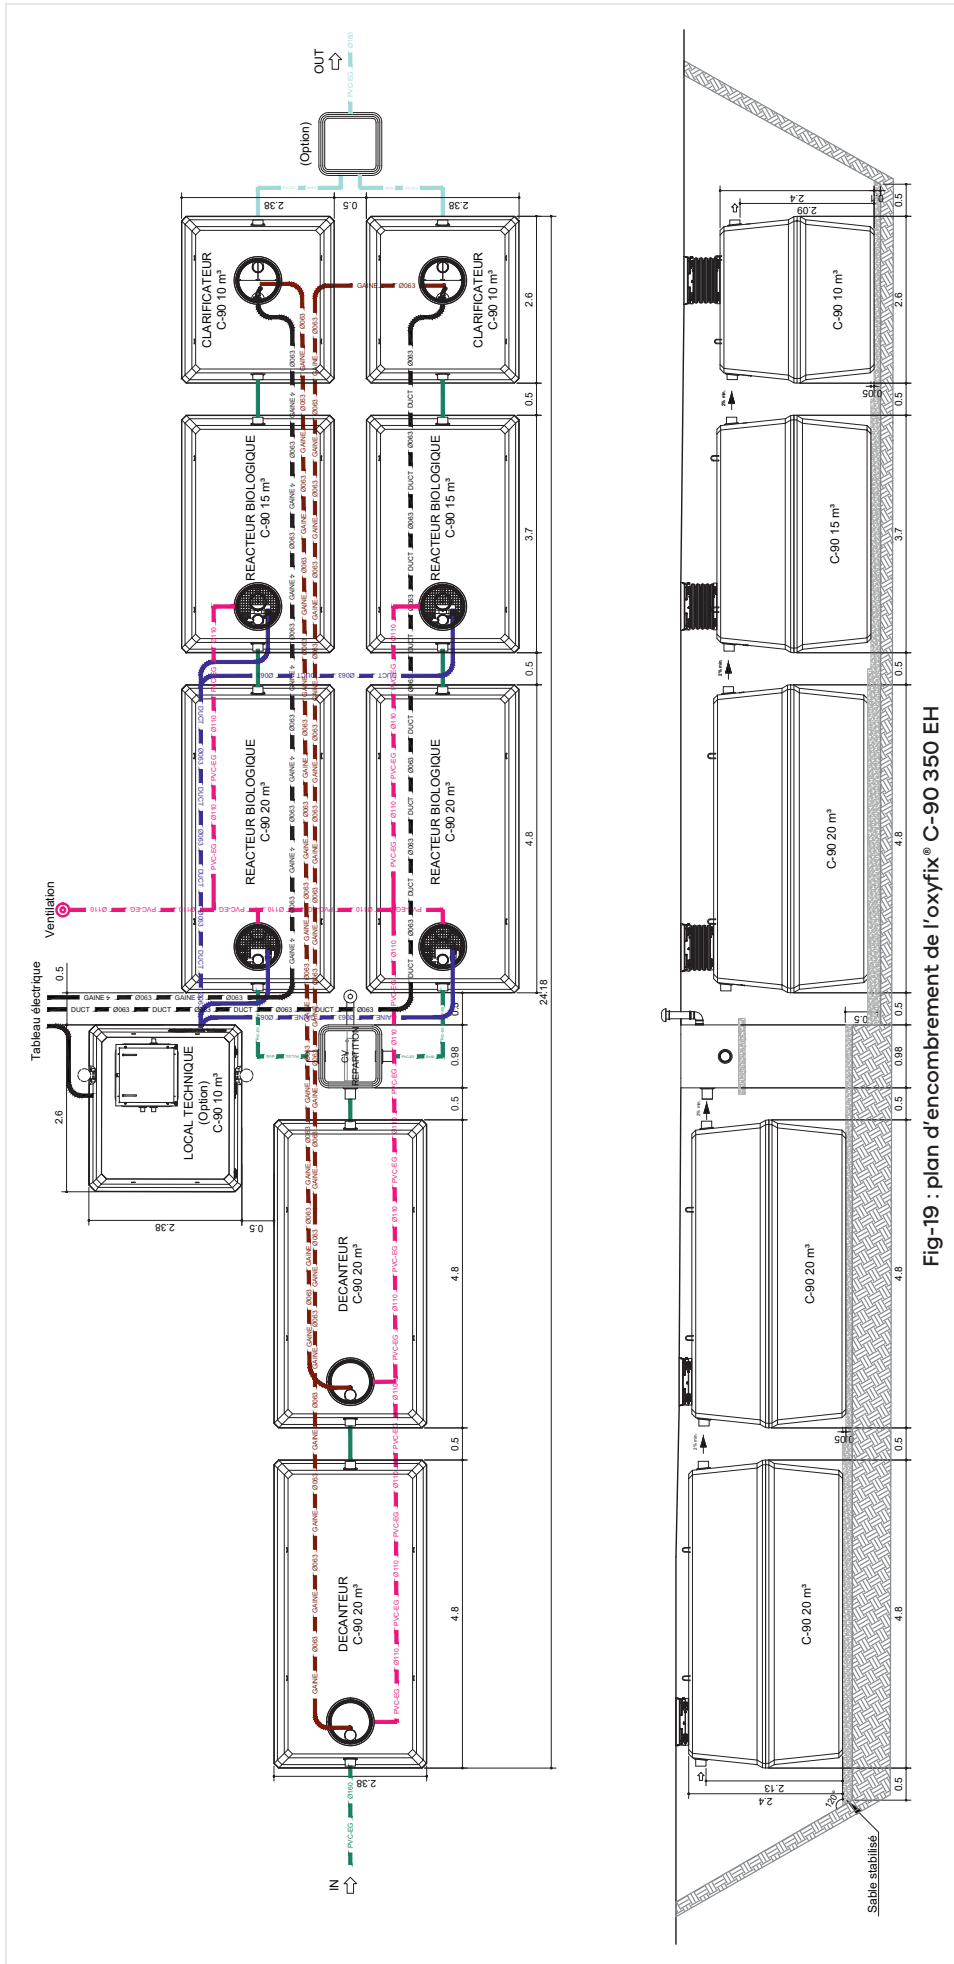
plan d'encadrement de l'oxyfix® C-90 350 EH
